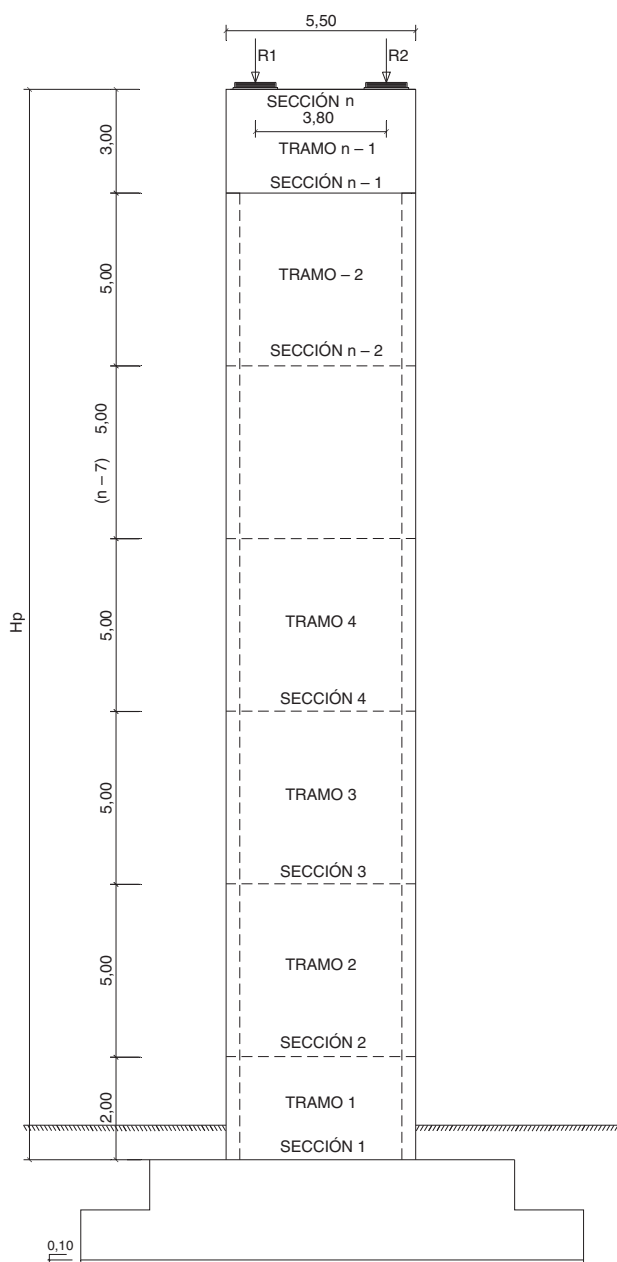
Alzado pila de hormigón armado con sección rectangular hueca.
